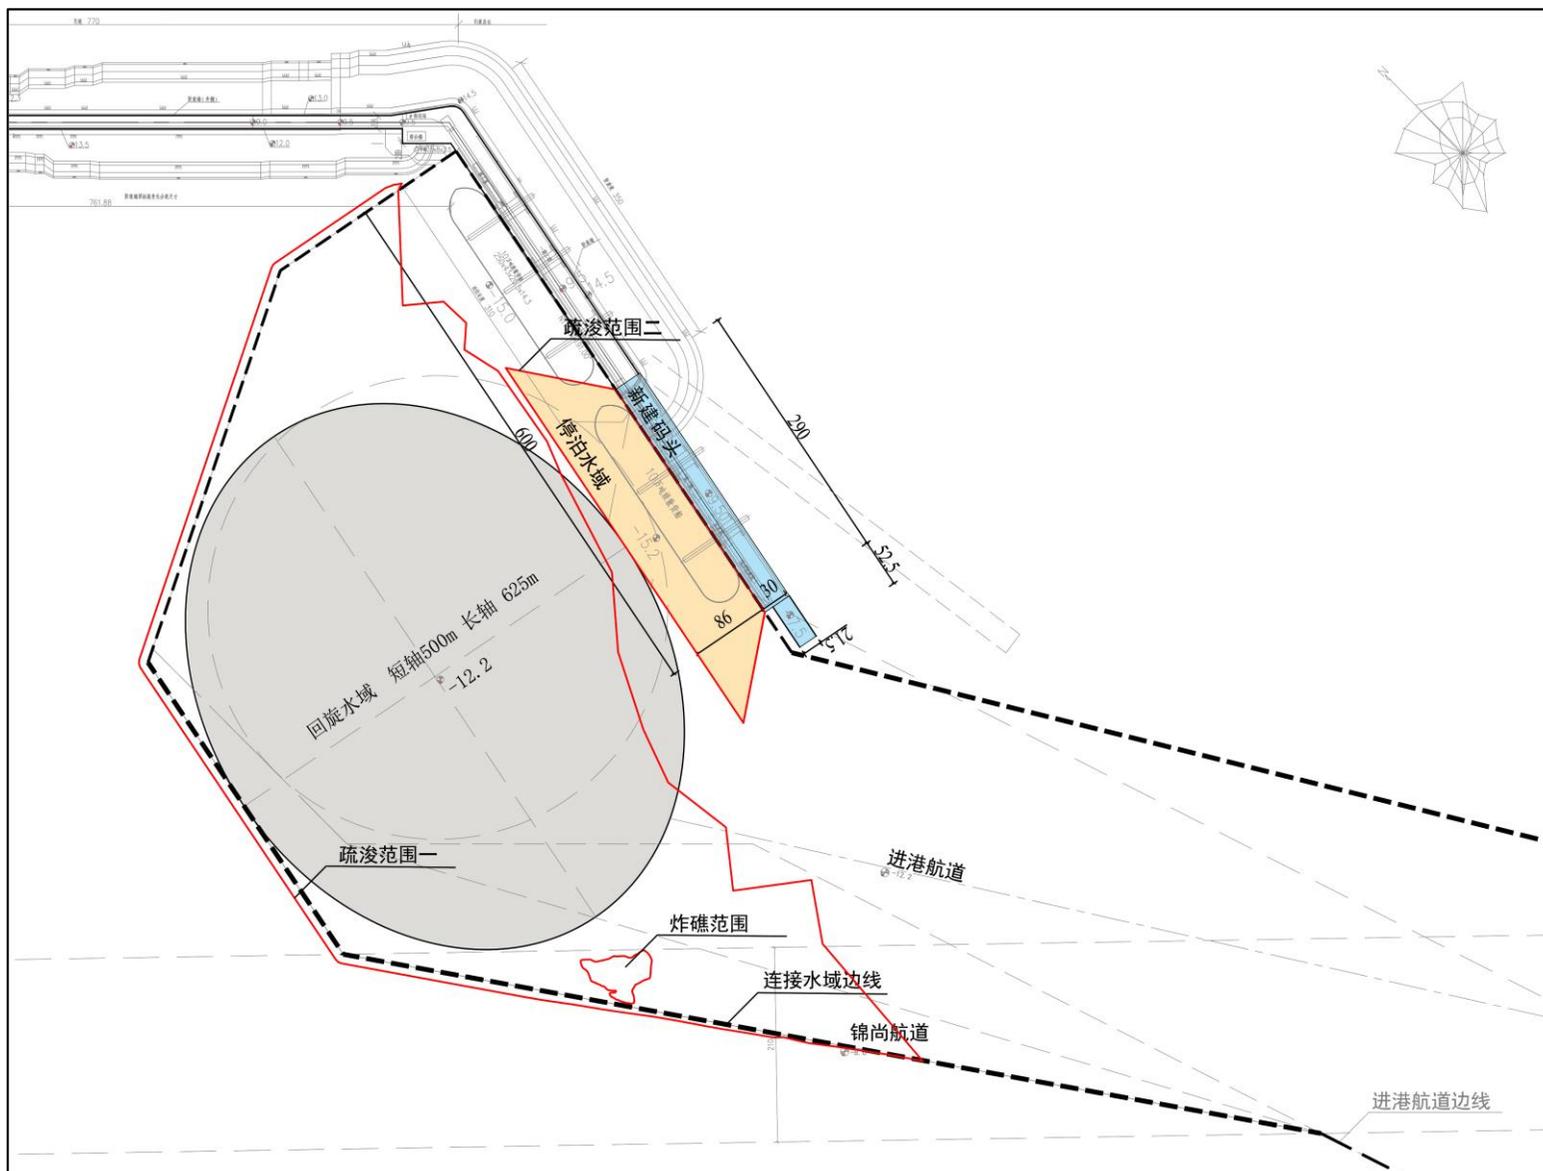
锦尚作业区 6 号泊位总平面布置图
